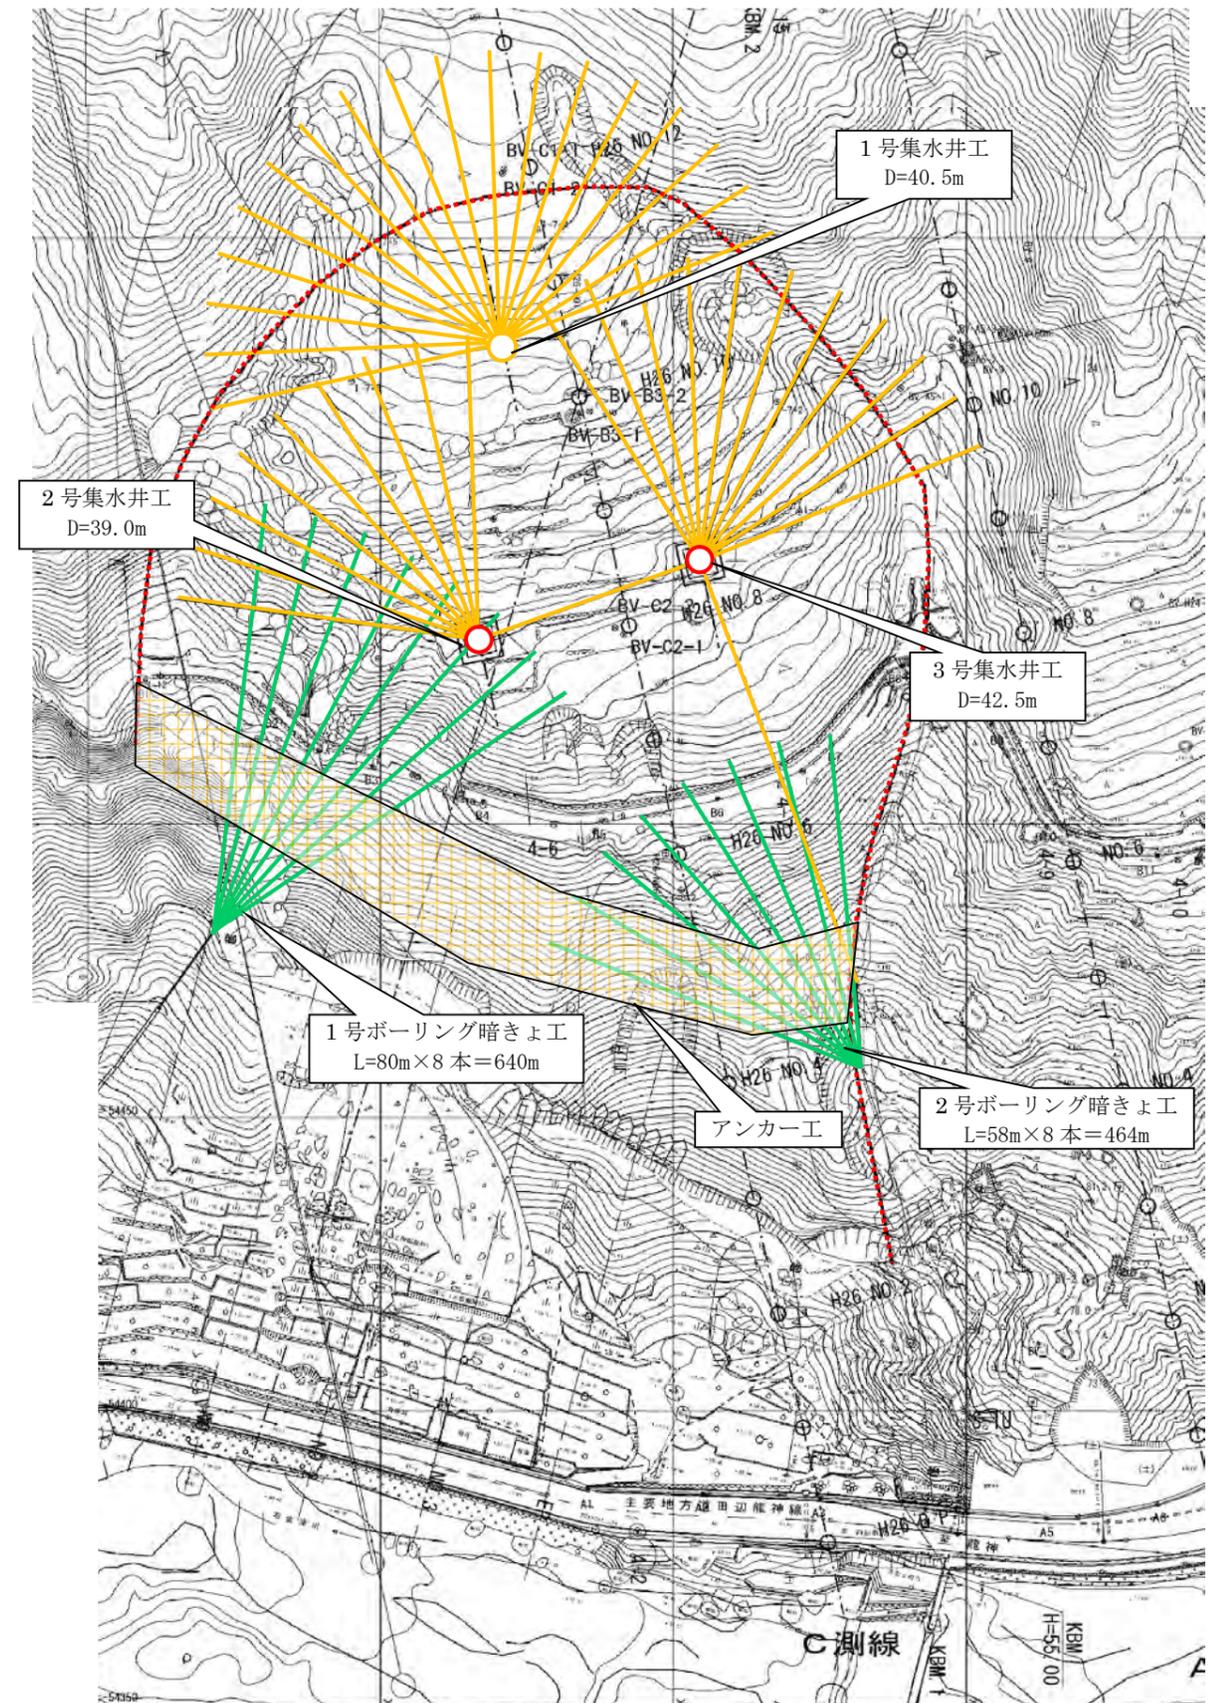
対策工平面図 (A-1 ブロック拡大図)
